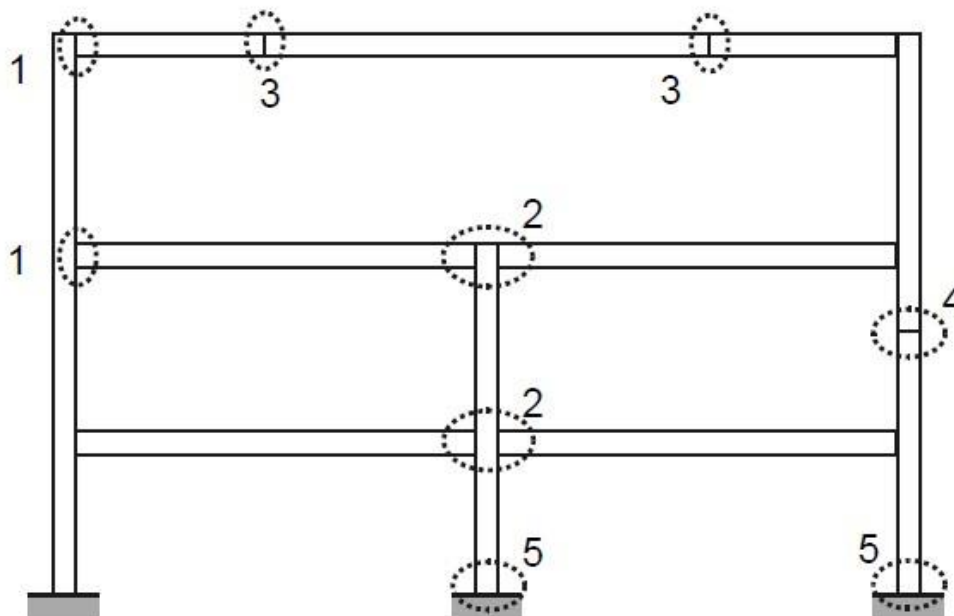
Tipos de uniones en las que puede aplicarse el modelo T-stub. (1)
